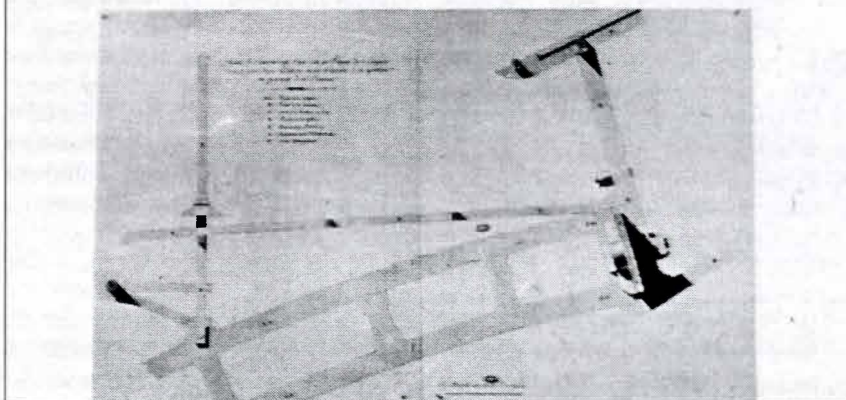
Cubierta de Belanger para "La halle". Detalles
